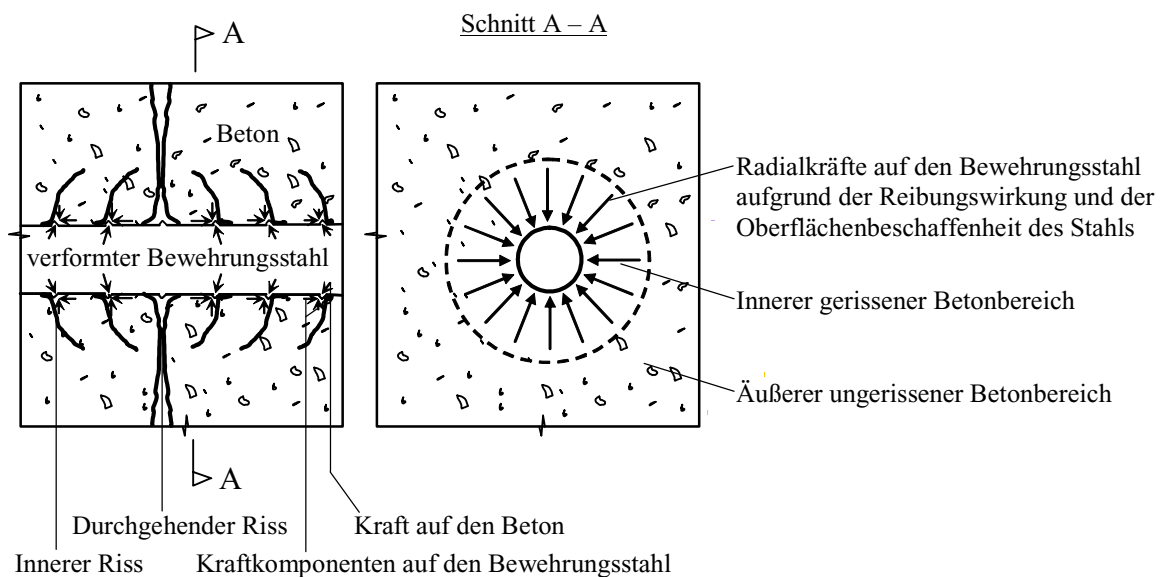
Verformungen des Betons um einen eingebetteten Bewehrungsstahls beim Ausziehversuch nach der Bildung innerer Risse, nach [74]
